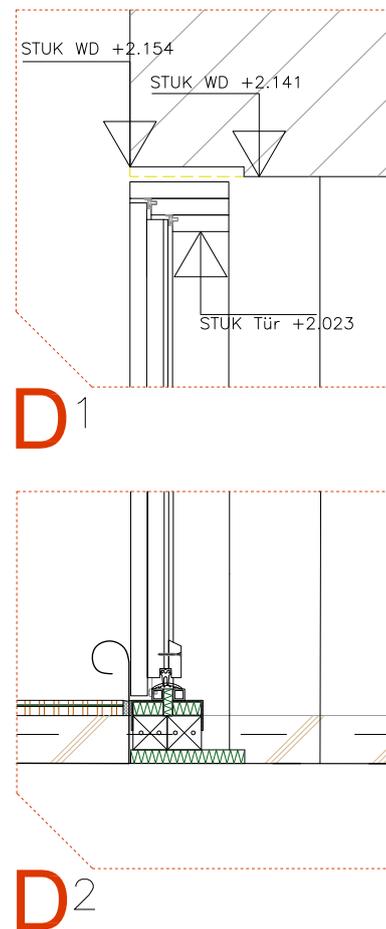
Detail 1 und 2: Kopf- und Fußpunkt Tür 2, M = 1:5
